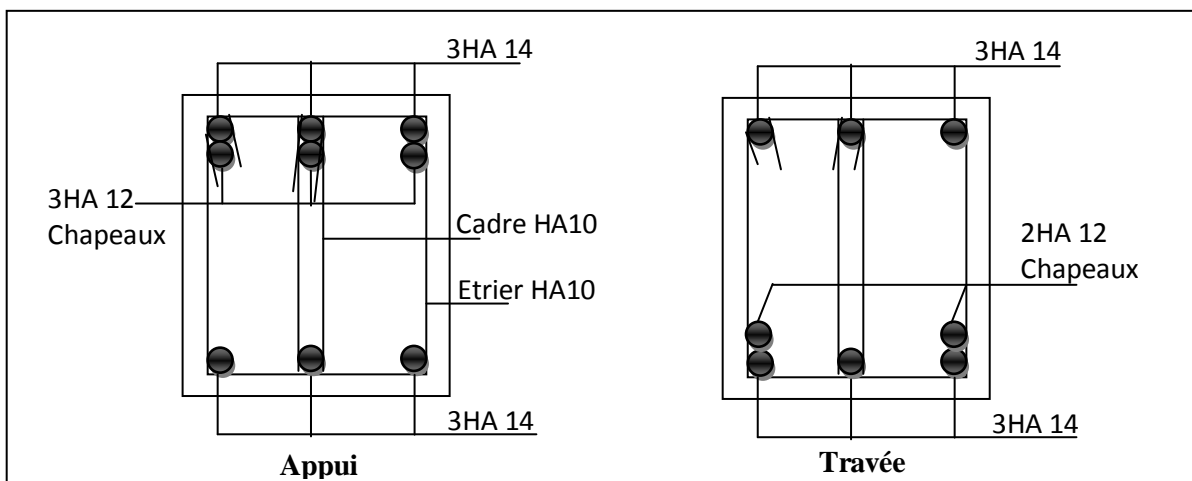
Schéma de ferrailage de la poutre principale du plancher RDC
